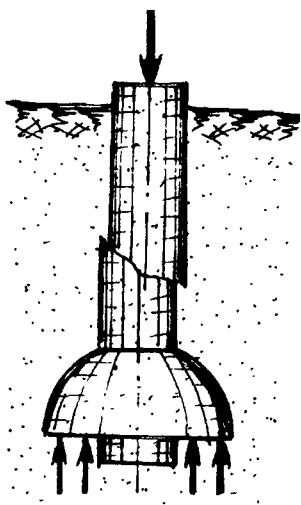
Срез опоры без арматуры от действия вертикальной нагрузки
